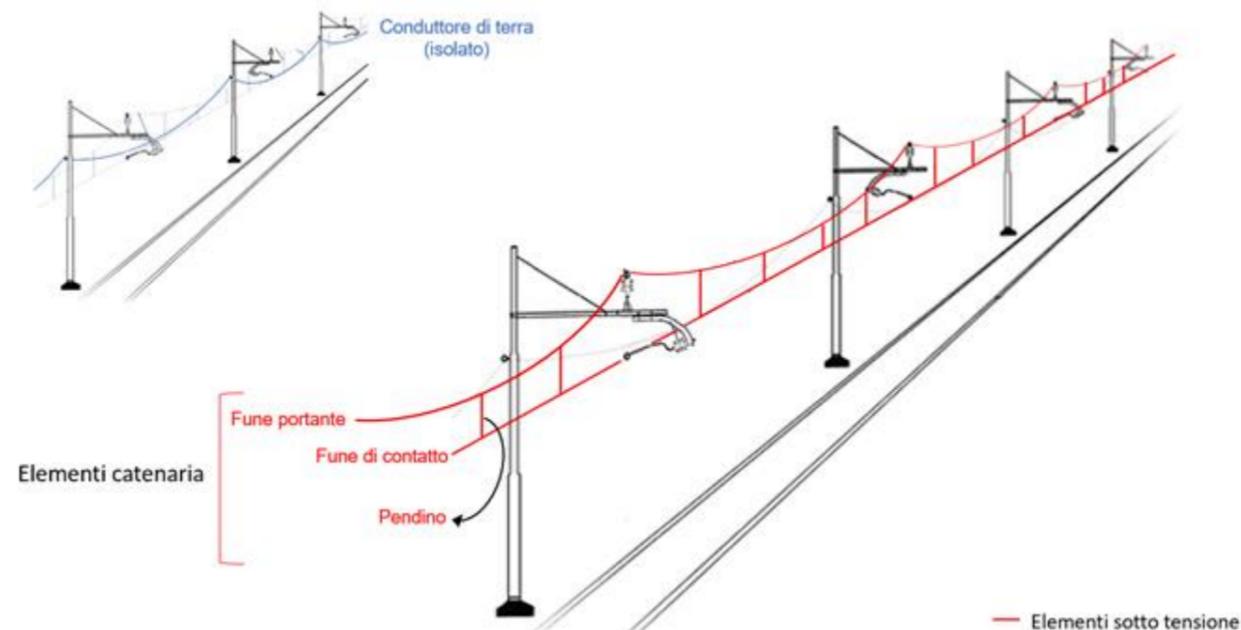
Elementi sotto tensione della componente aerea della linea di trazione elettrica ferroviaria
